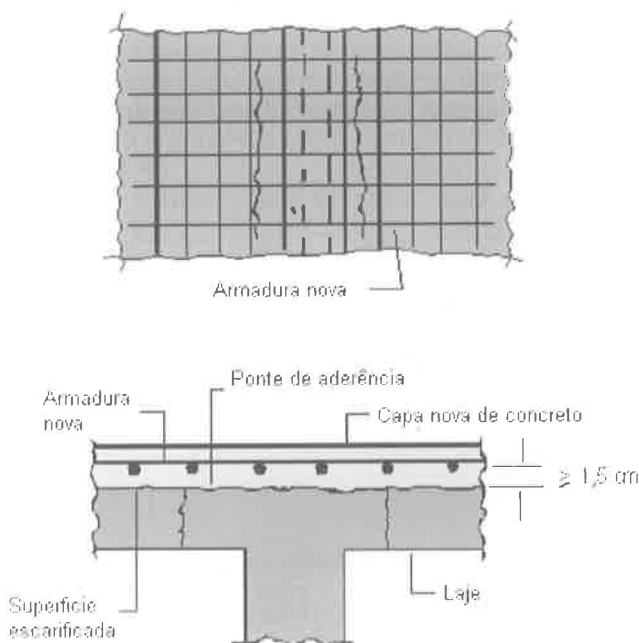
Reforço de flexão em lajes com concreto.
